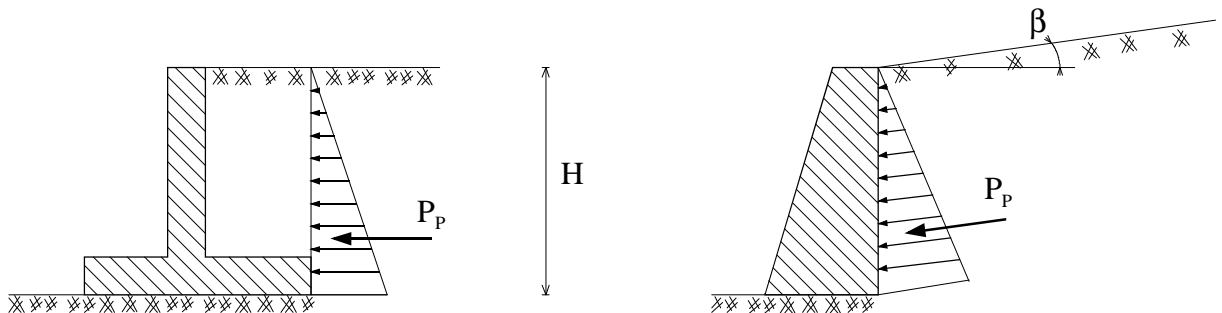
Force de poussée s'exerçant sur un mur de soutènement.
